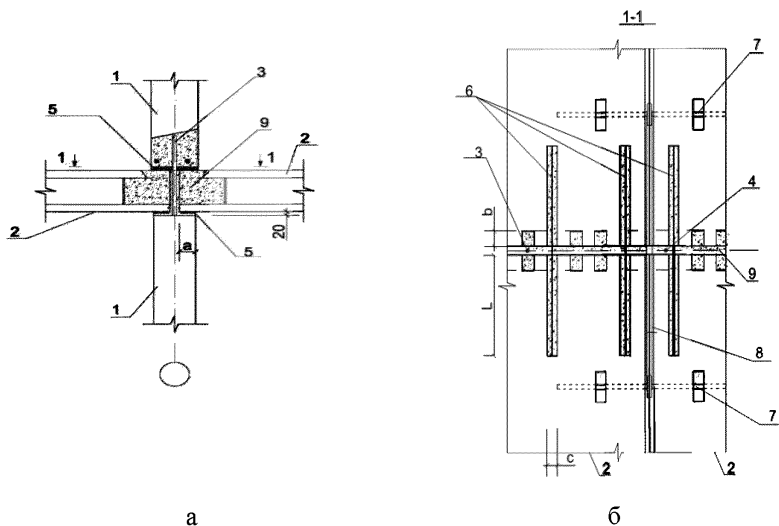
Стык плит перекрытий двухсторонний, платформенный: 1 – внутренняя стенная панель; 2 – плита перекрытия; 3 – выпуск арматурный длинный; 4 – выпуск арматурный короткий; 5 – цементно-песчаный раствор; 6 – каркасы замоноличенные; 7 – монтажные стержни для подъема плит; 8 – арматурные стержни в шве между плитами перекрытий; 9 – бетон
